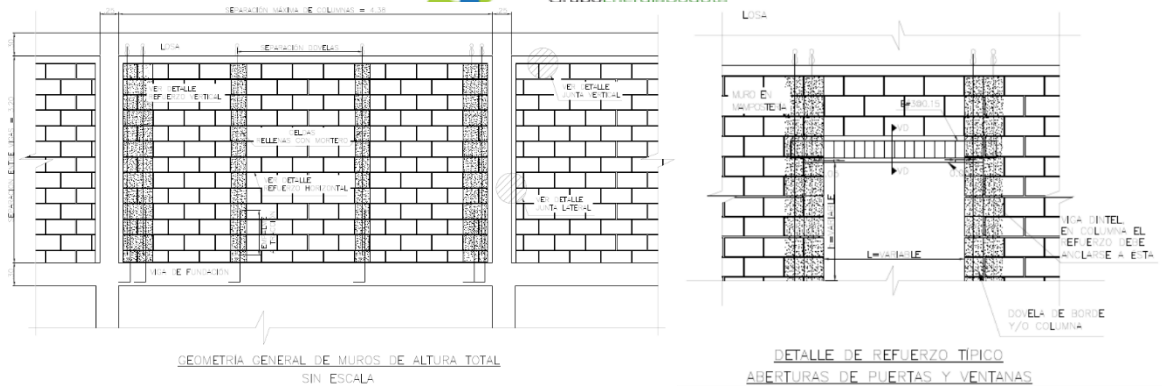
Reforzamiento típico de muros edificio de control (cantidad, tipo y separación de acuerdo al diseño de detalle).
